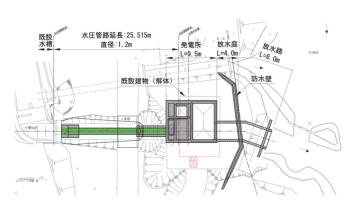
水槽・水圧管路・発電所・放水路更新設備平面図
